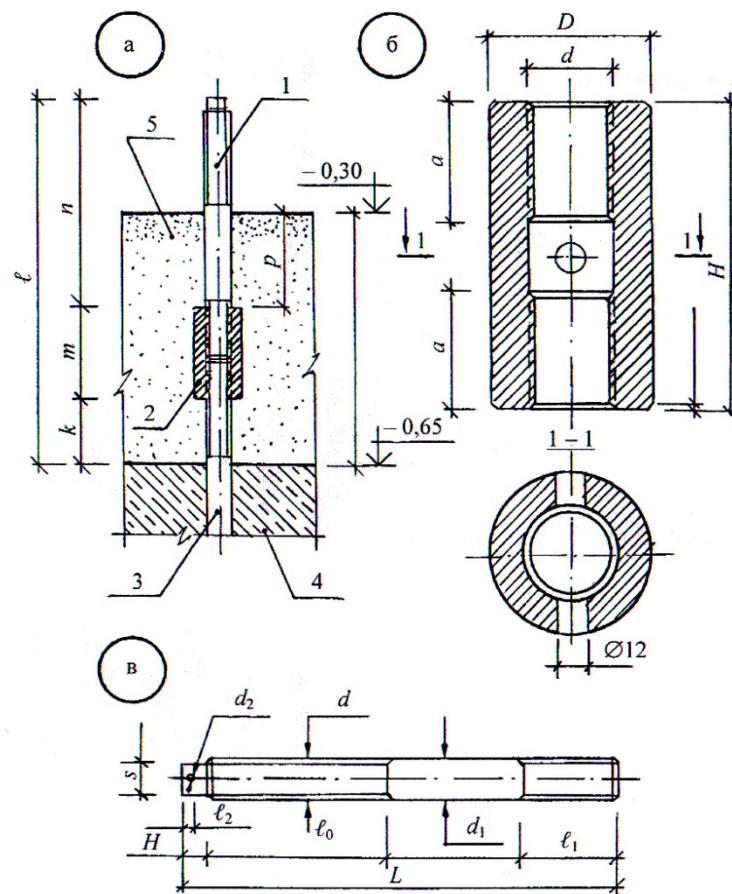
Конструкция наращивания (удлинения) фундаментных болтов: а – общая схема; б – муфта соединительная; в – дополнительная шпилька; 1 – дополнительная шпилька; 2 – муфта соединительная; 3 – наращиваемая шпилька фундаментного болта; 4 – бетон фундамента; 5 – бетон наращивания.
